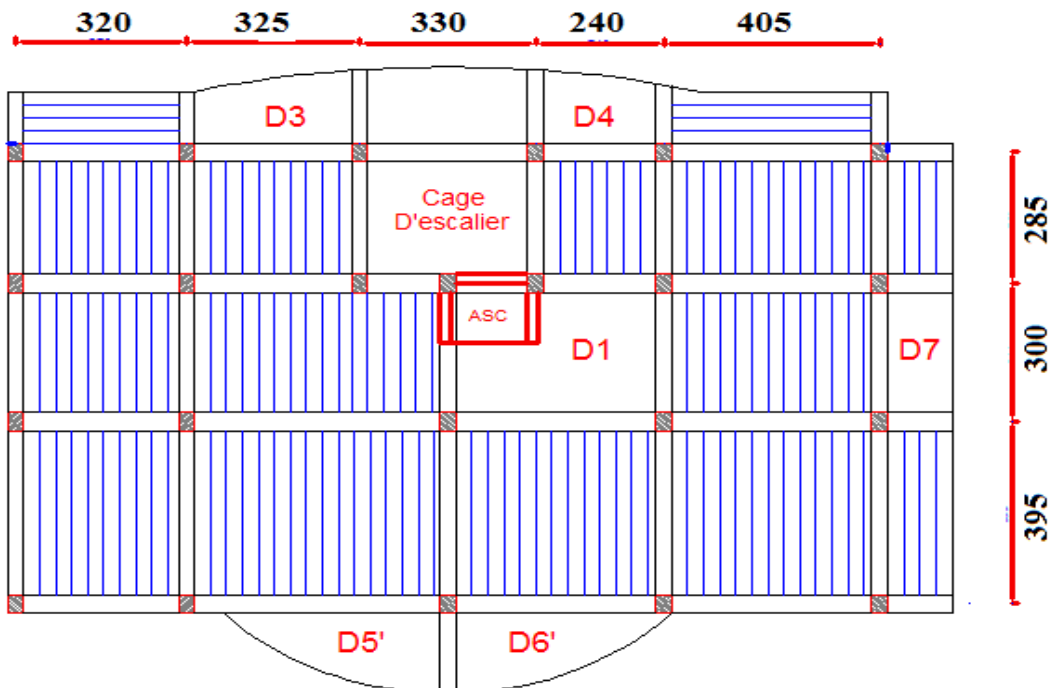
Schéma de la disposition des poutrelles de l'étage 10.
